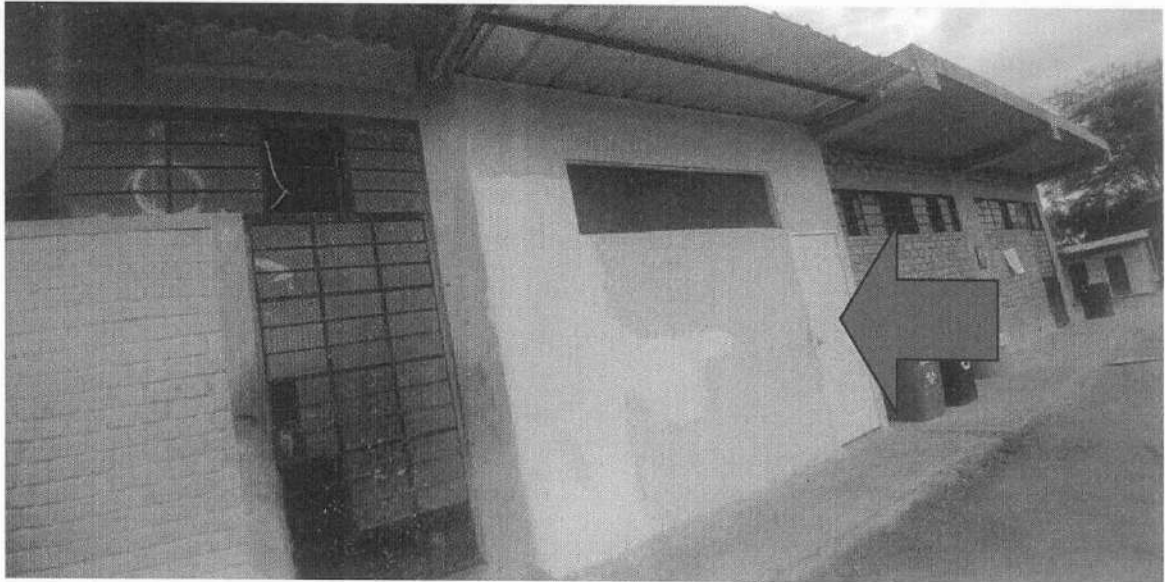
PUEDE VERSE EL AULA DE SECUNDARIA TOMANDO EL ESPACIO EXISTENTE ENTRE LAS AULAS CONSTRUIDAS HACE 25 AÑOS POR FONCODES Y EL AULA CONSTRUIDA EL AÑO PASADO. LA PLANCHA DE CARTON YESO (SISTEMA DRYWALL) SE ESTA DETERIORANDO CON LAS LLUVIAS PRESENTADAS EN EL MES DE FEBRERO DEL PRESENTE AÑO. PUEDE VERSE QUE EL AULA NUEVA NO TIENE COBERTURA A PESAR QUE LA LOSA ALIGERADA ES HORIZONTAL.
